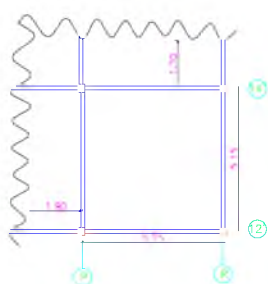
Sector de losa piso 1 bloque Sur-Este edificio de la Gobernación
